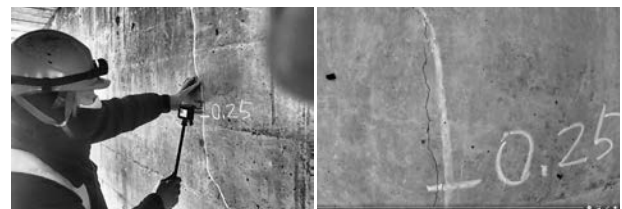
B橋: RCのひび割れ (アクションカメラ)
